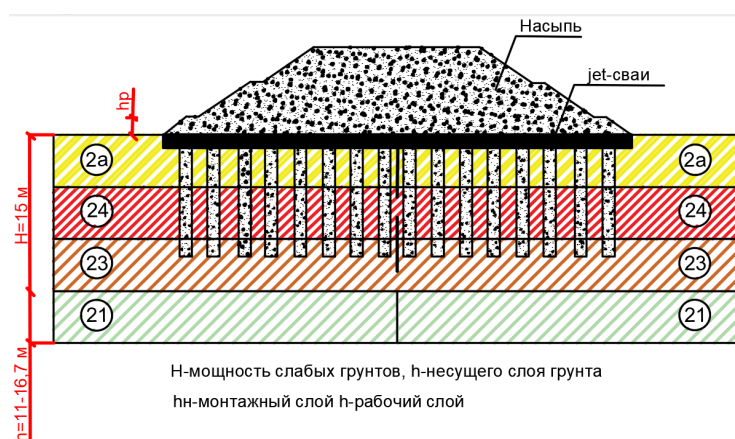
Устройство основания насыпи щебеночными сваями с жестким железобетонным ростверком
